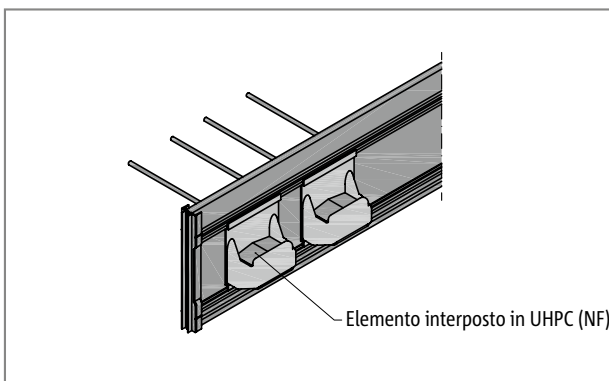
Schöck Tronsole® tipo T: dettaglio della mensola di supporto; fabbricazione inversa
